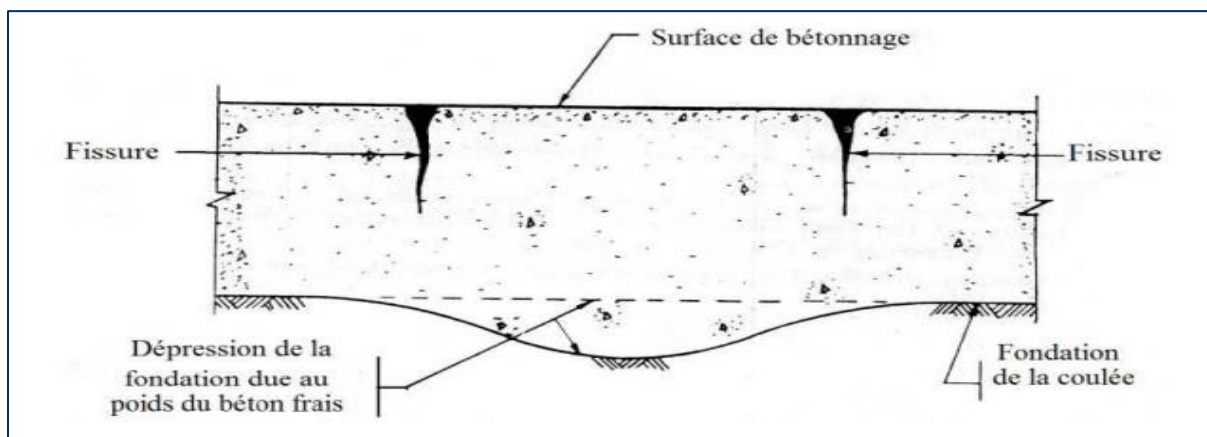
Fissure due au tassement de fondation pendant a construction
